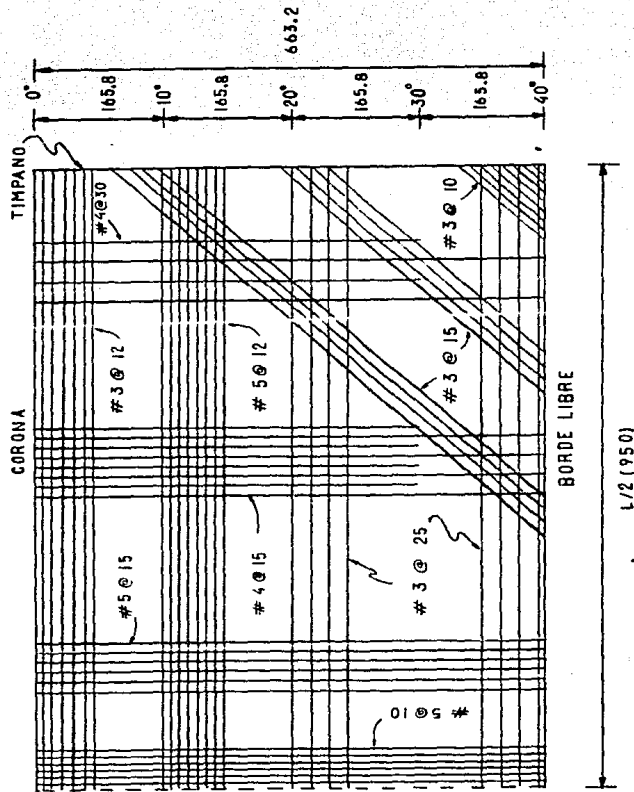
Detalle del armado del cascarón cilíndrico largo de concreto reforzado.
